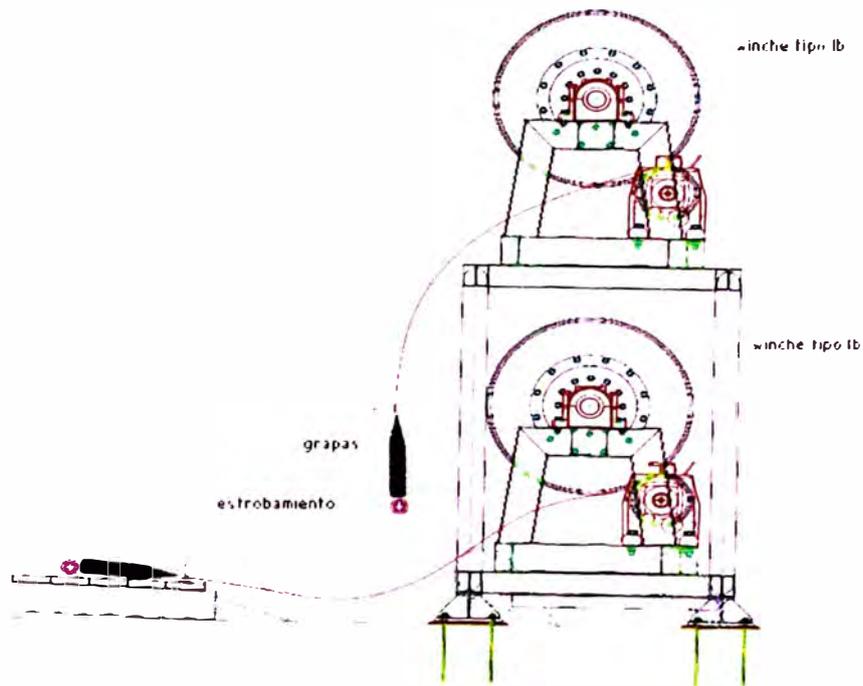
ESQUEMA DE WINCHES IB CANAL MARGEN IZQUIERDO
